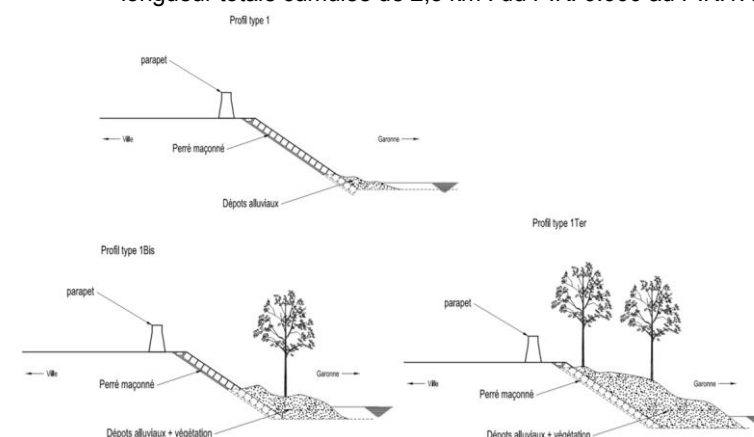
Coupe type : digue avec perré maçonné / parapet - Profil type 1
